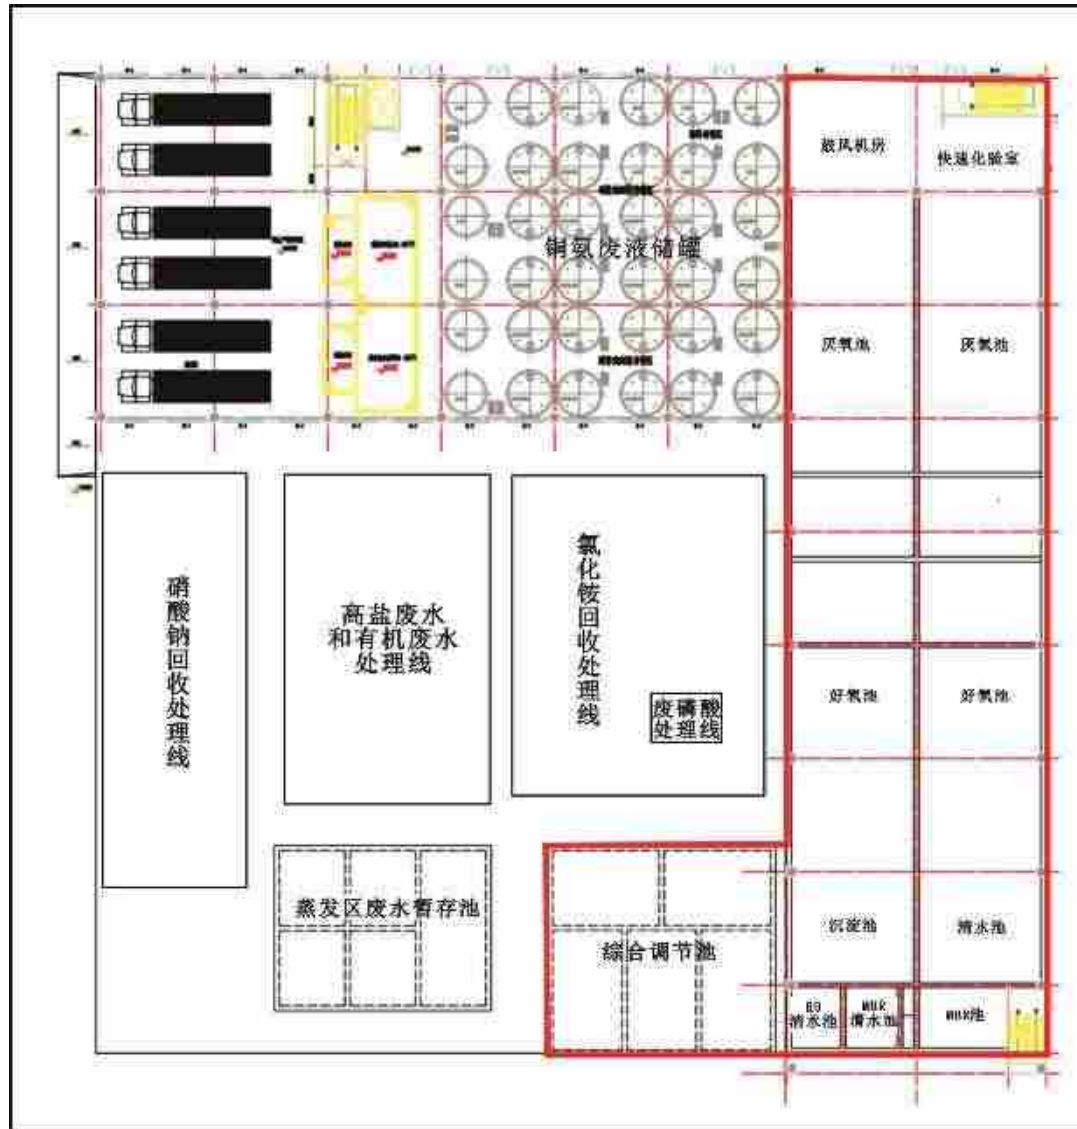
(1) 本次改扩建后 7#\*厂房 1 层平面布置图 (红色范围内为污水处理站平面图)
